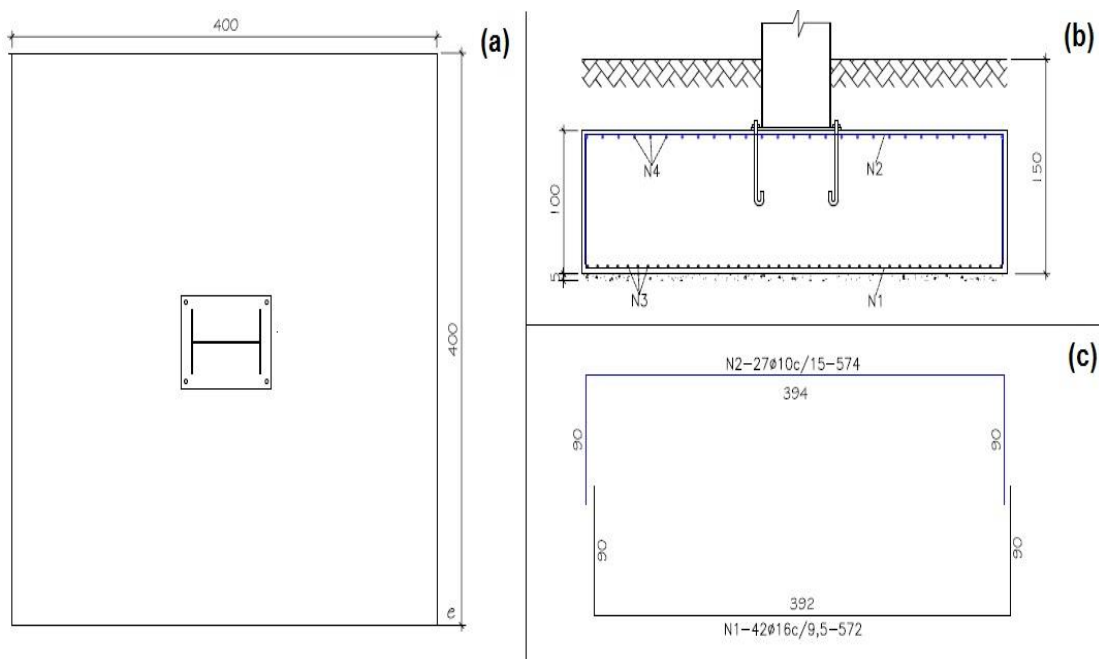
Detalhes estruturais da sapata. (a) localização do pilar e dimensões em planta; (b) dimensões em corte e detalhe da ligação pilar-sapata; (c) detalhe estrutural da armadura.
